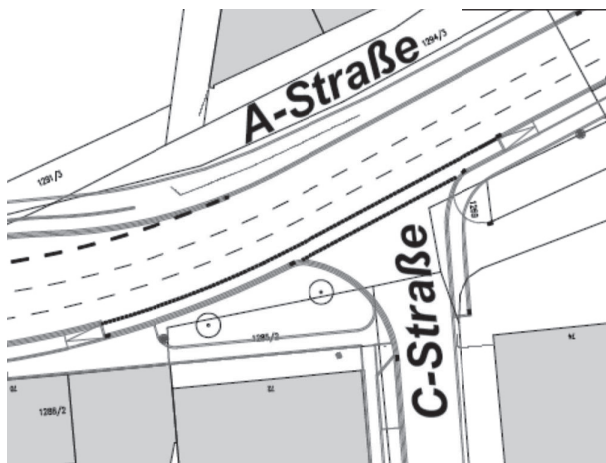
Lageplan Knotenpunkt C-Straße Beispiel 1
